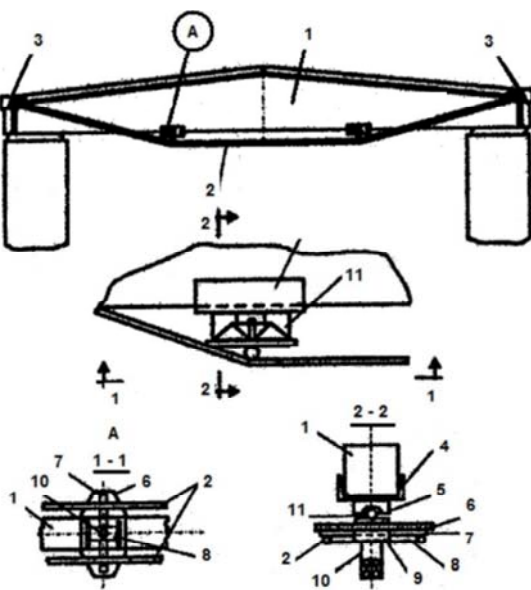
Усиление сборной железобетонной балки покрытия шпренгелем:
